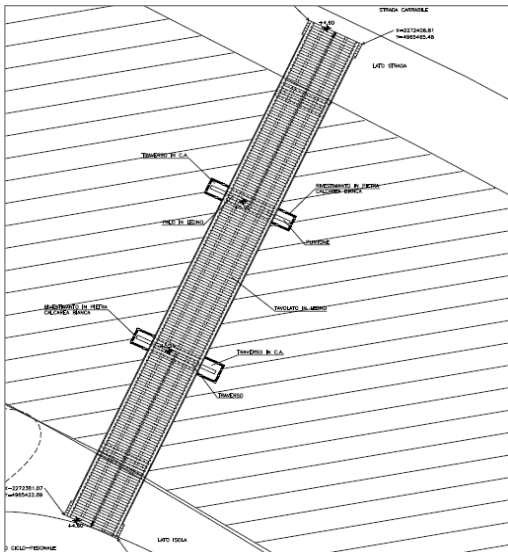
Planimetria passerella ciclo-pedonale da progetto PREGRESSO
